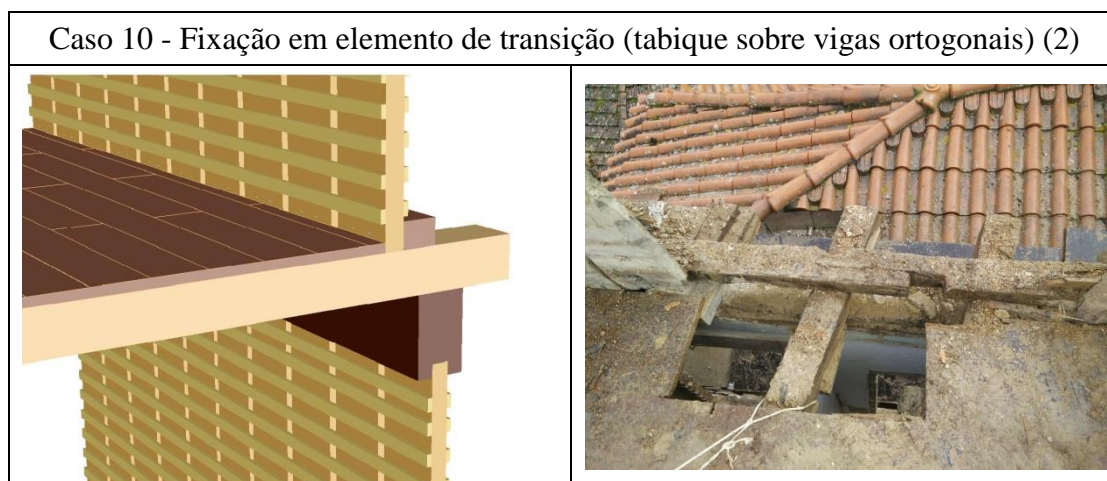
Ligações inferiores de tabique a vigas ou outros elementos - Caso 10
